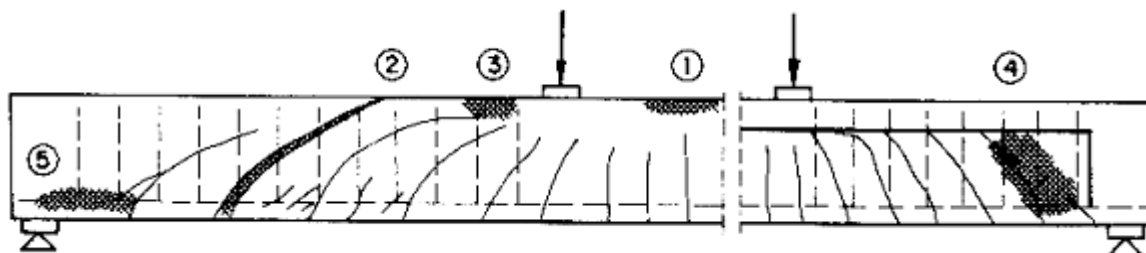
Armadura transversal de una viga fisurada simplemente apoyada.
